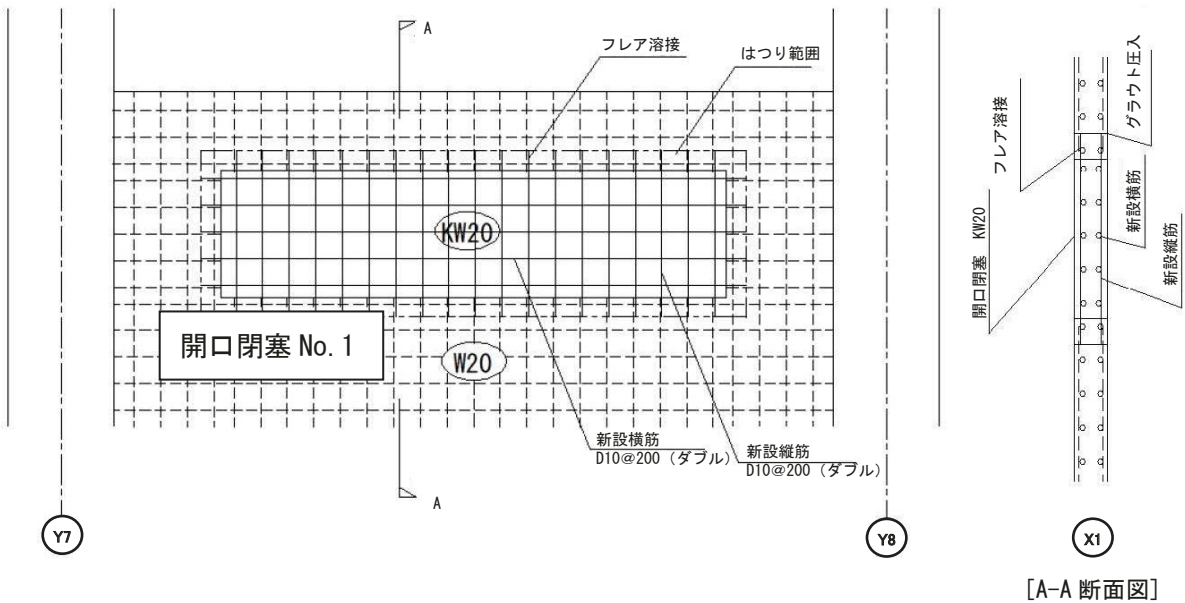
解体分別保管棟の開口閉塞 (No.1) 施工詳細図
